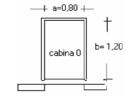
Dimensión de cabina. Fuente: Instalaciones electromecánicas
